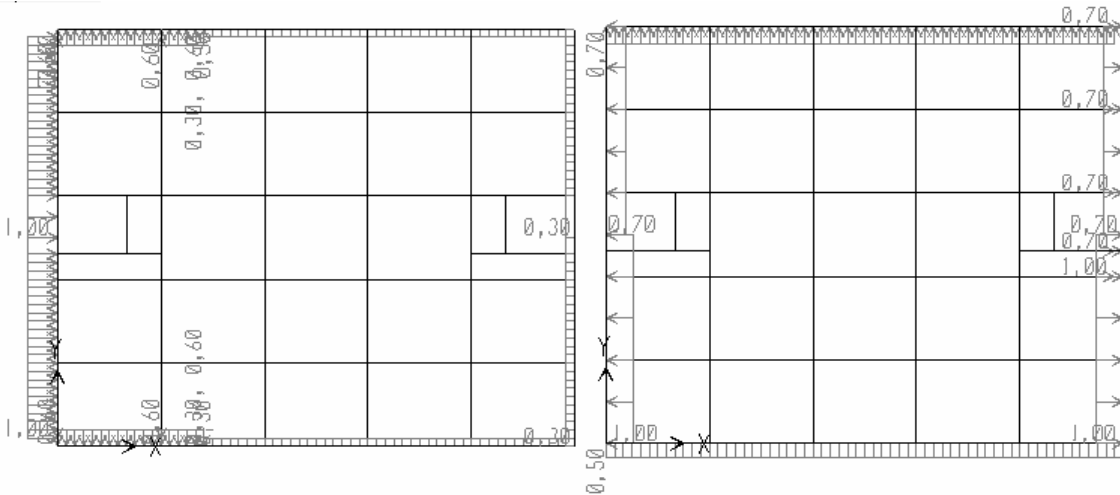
Carregamento de vento no pavimento térreo nas direções x e y.
